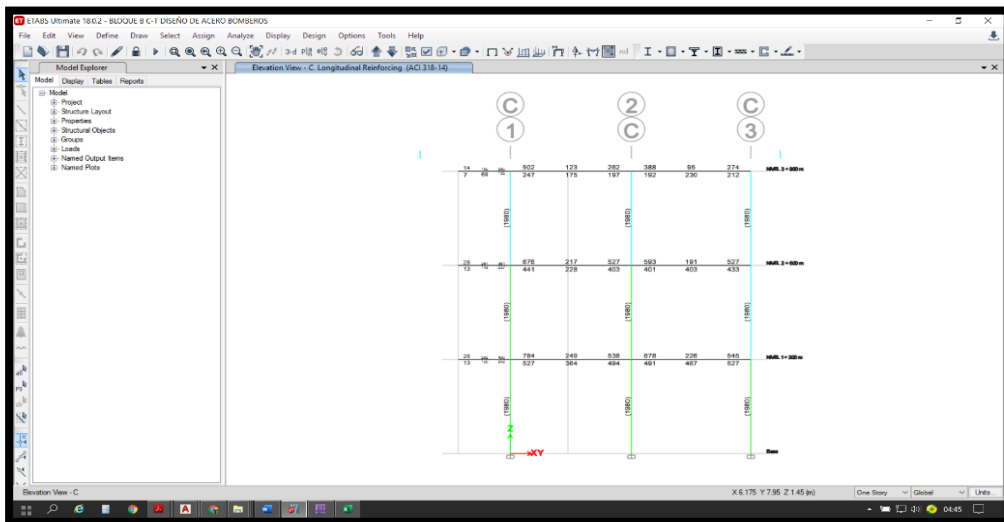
Bloque A - Acero longitudinal en el eje elevación eje C-C
